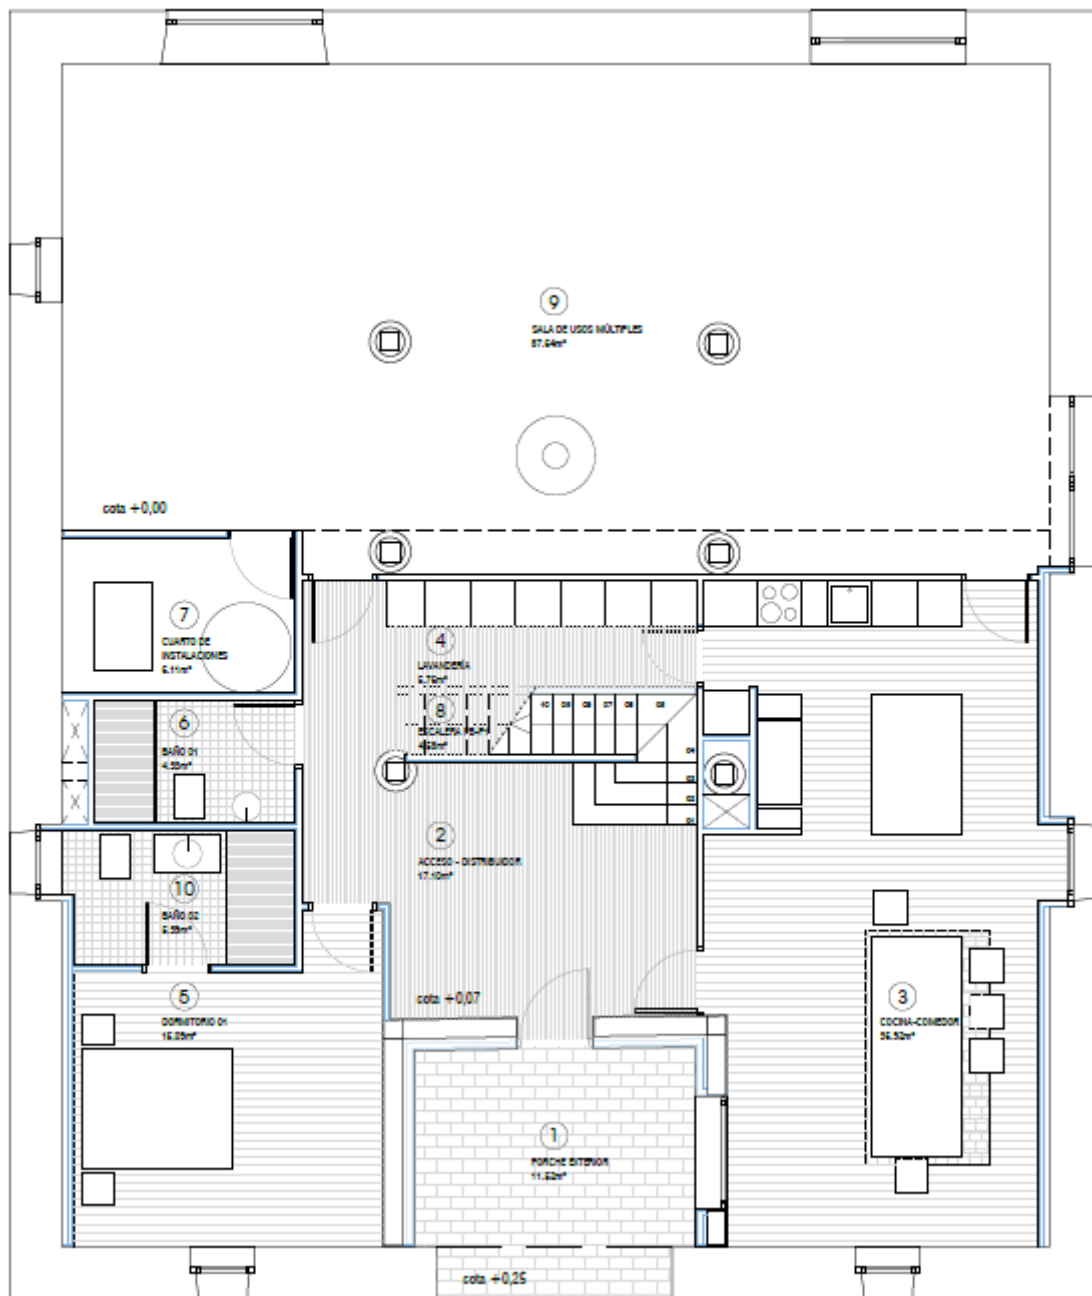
Distribución y superficie Planta Baja (Plano 04.1)
